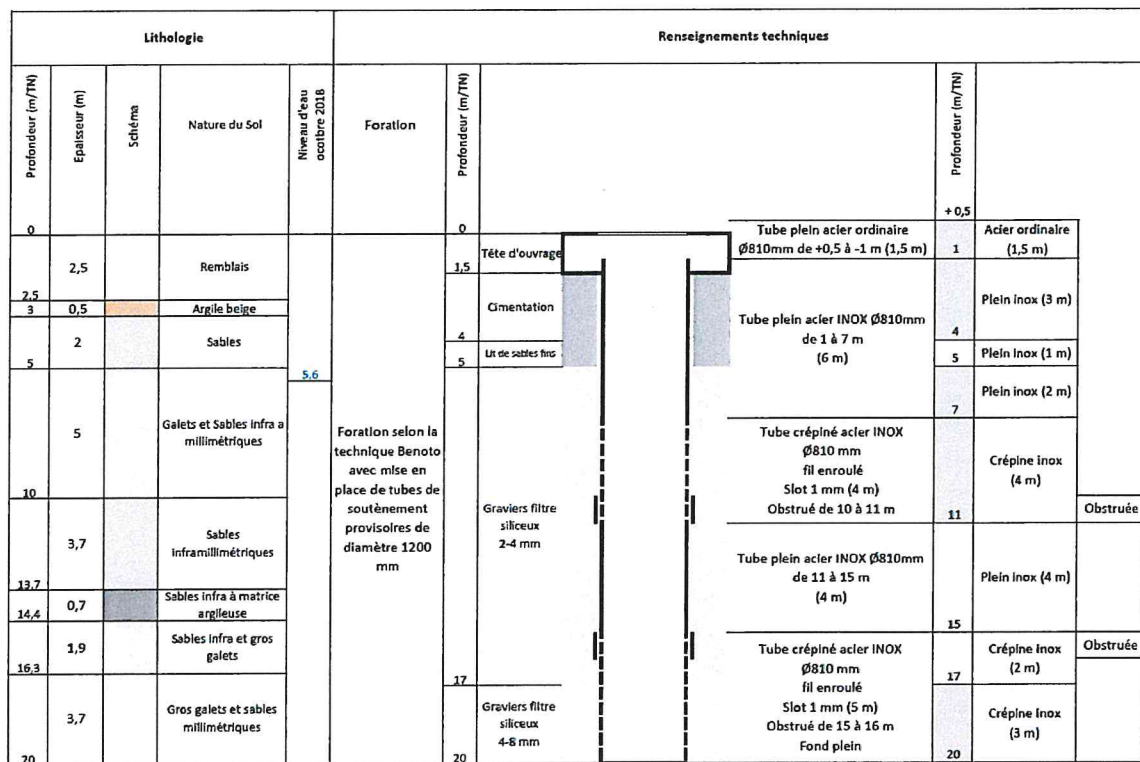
Coupe lithologique du forage de géothermie au droit du site
